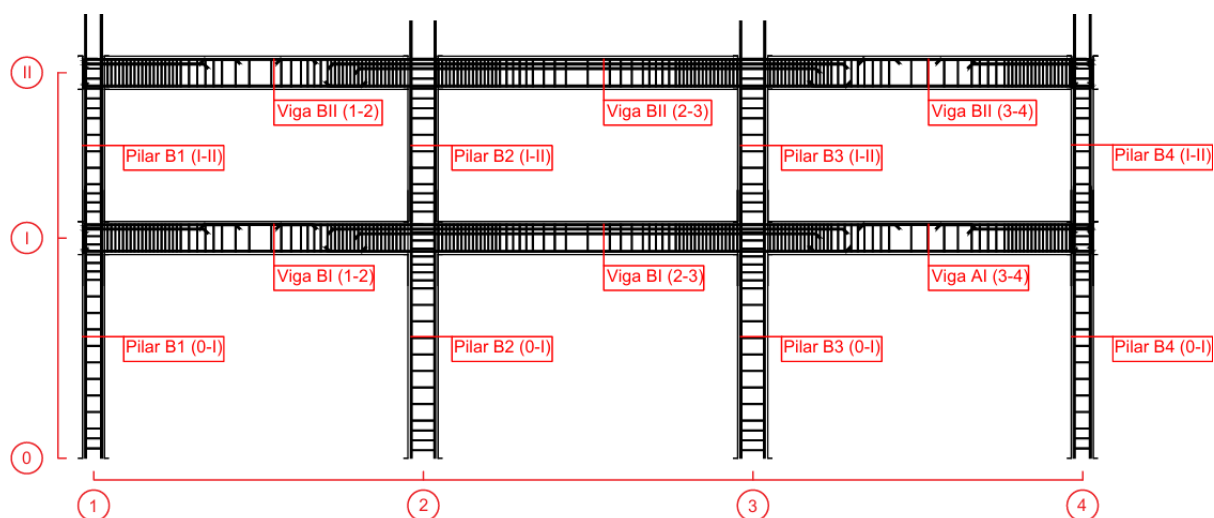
Pormenor de armaduras do 1º e 2º piso do alinhamento B – edifício de 6 pisos
